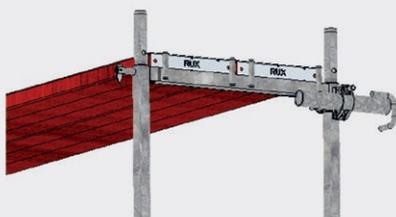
Kurzer Gerüsthalter, Ausführung ohn
